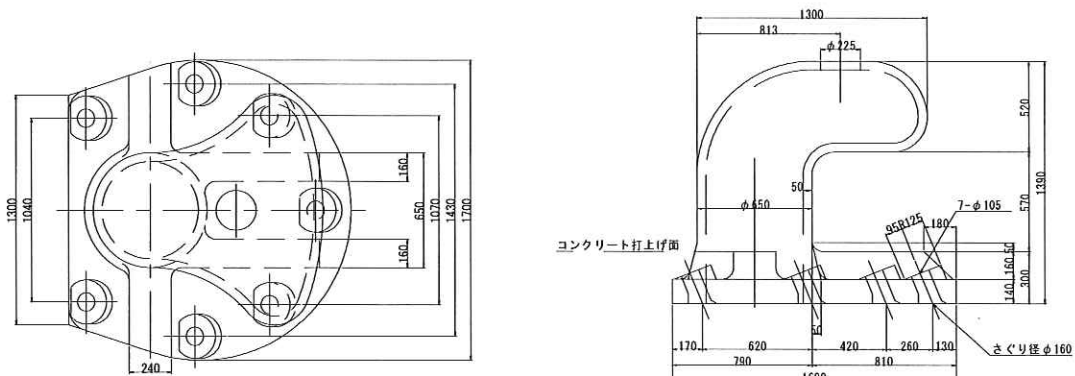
係船柱構造図(左：平面図、右：断面図)
